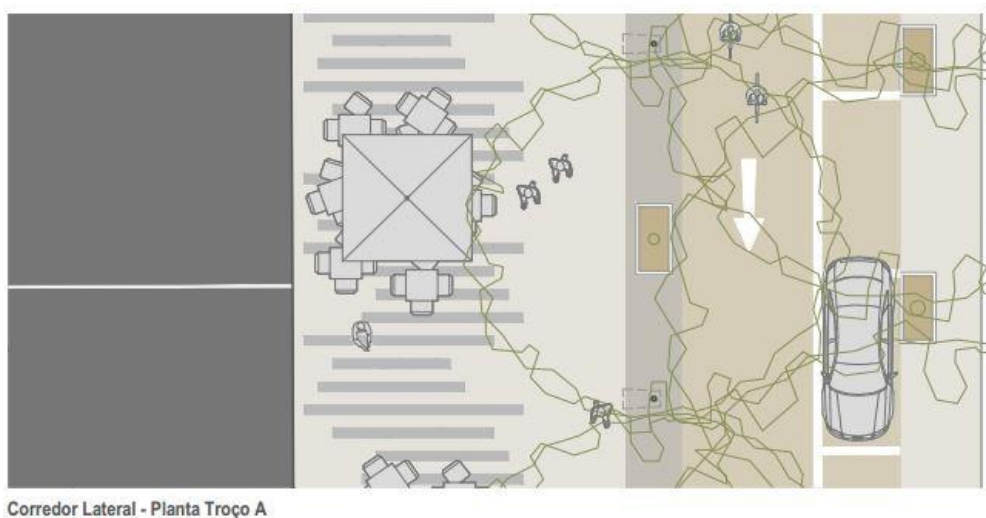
Planta do trecho A – corredor lateral Avenida da República
